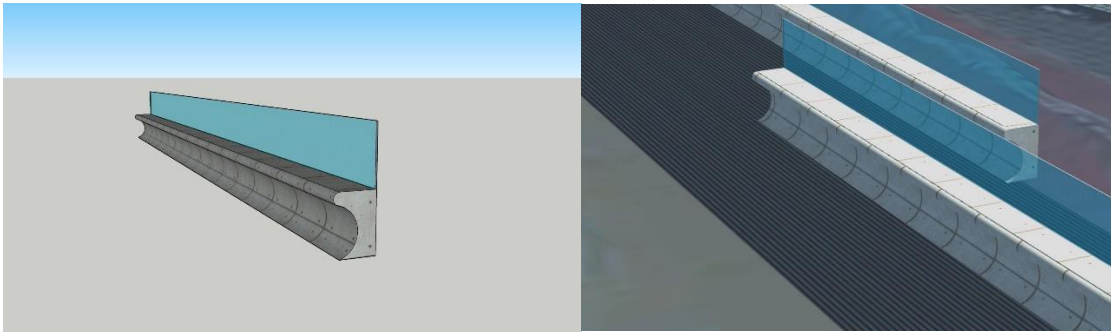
a) Desenho em 3D de um muro côncavo; b) Pormenor em zonas de descontinuidade.
